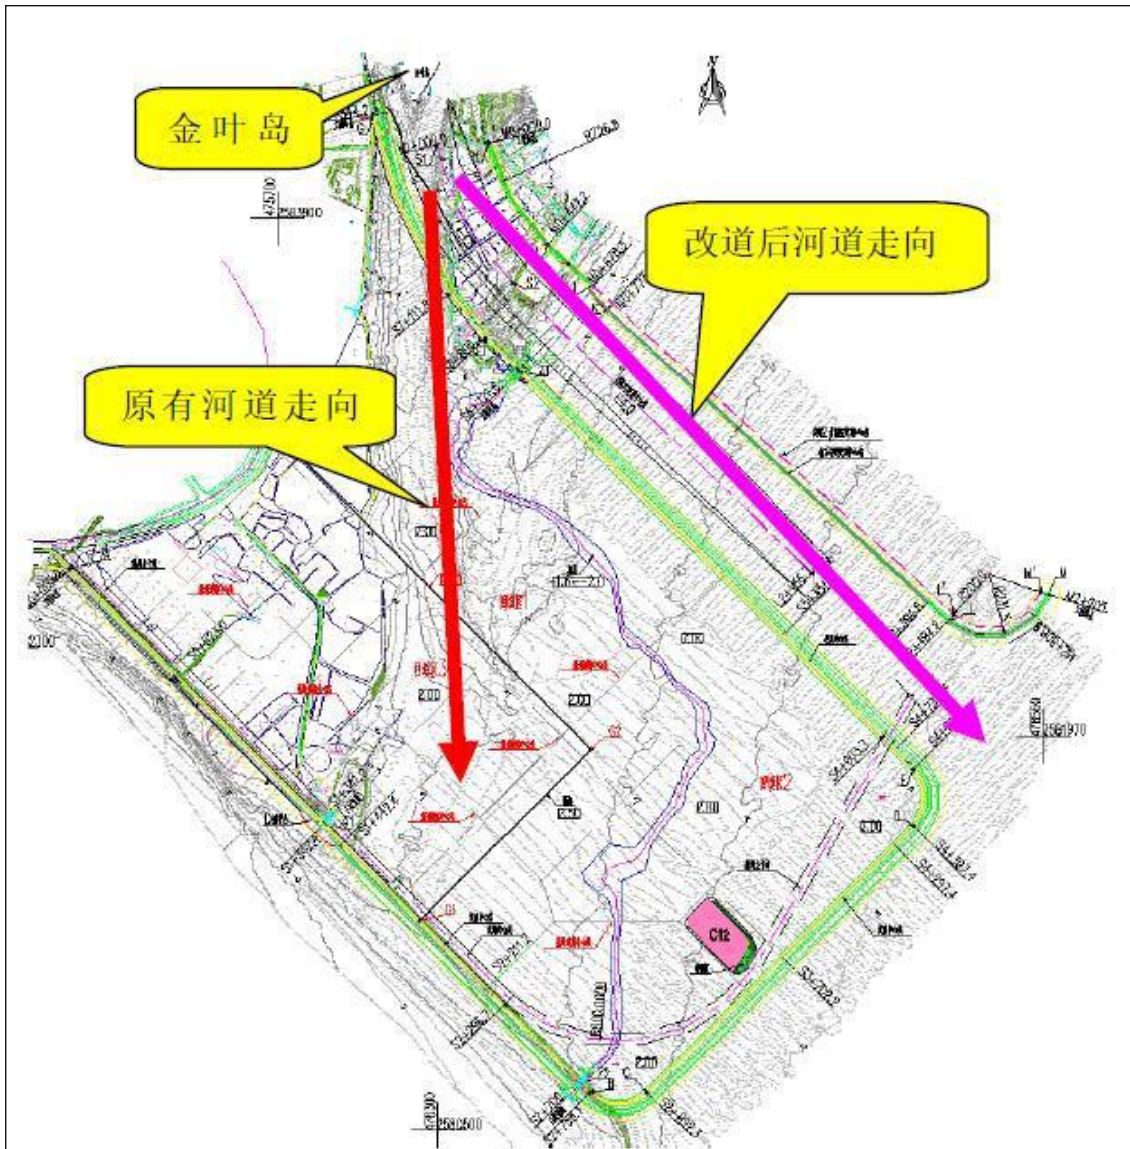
新津河河口旧航道与新挖航道布置图
